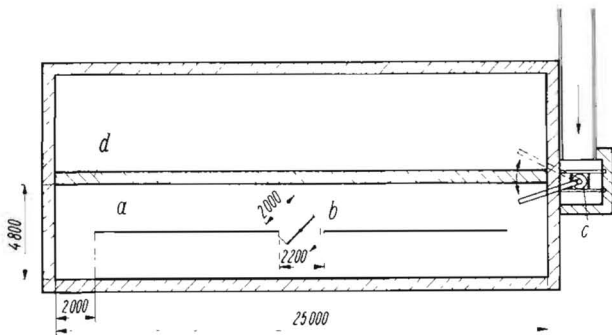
Güllegrube (zwei Kammern) mit Pumpenschacht (Draufsicht)
